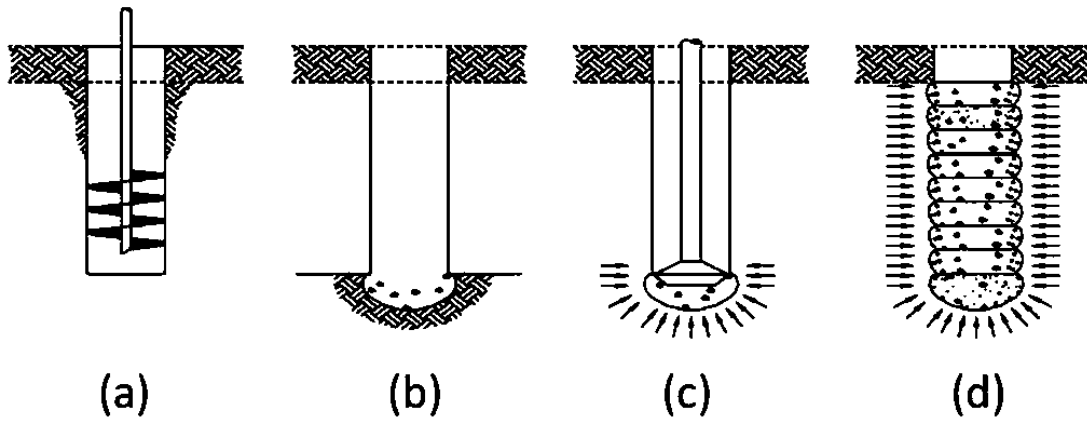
Procedimiento pilas geopier, a) perforación; b) Colocación de la capa de grava; c) Compactación de la capa de grava; d) Columna completa (Parra y Valverde, 2006)
